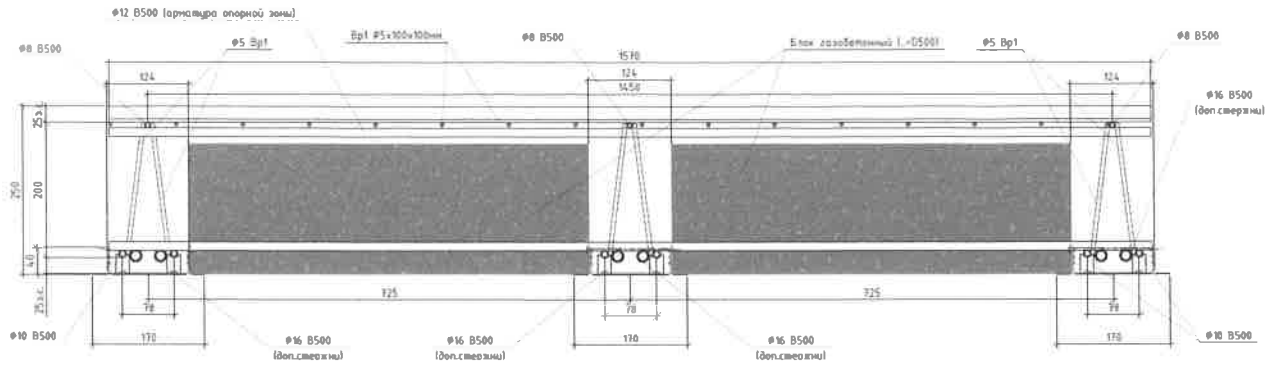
Общий вид поперечного сечения сборно-монолитного перекрытия
